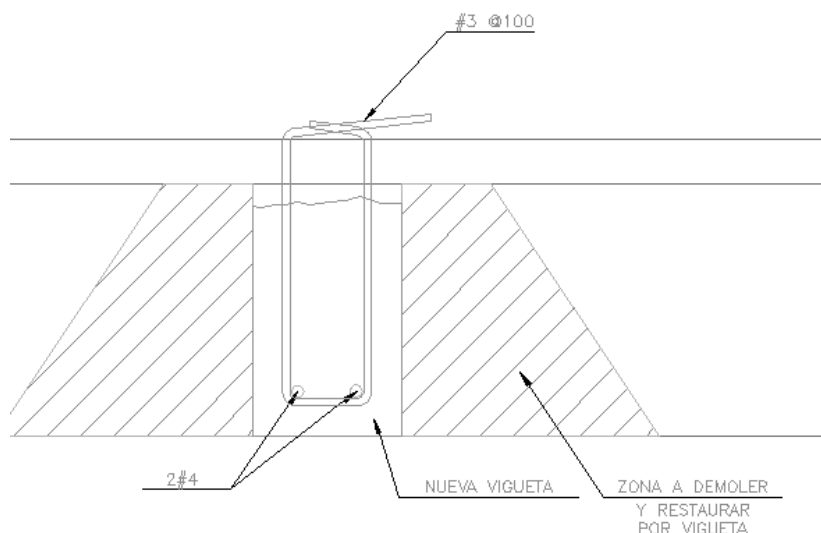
Zona a demoler y refuerzo y sección de las nuevas viguetas
